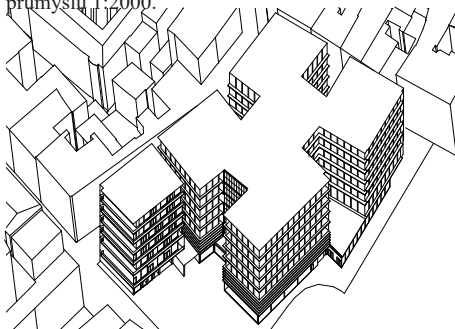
Axonometrie Domu uměleckého průmyslu 1:2000.
